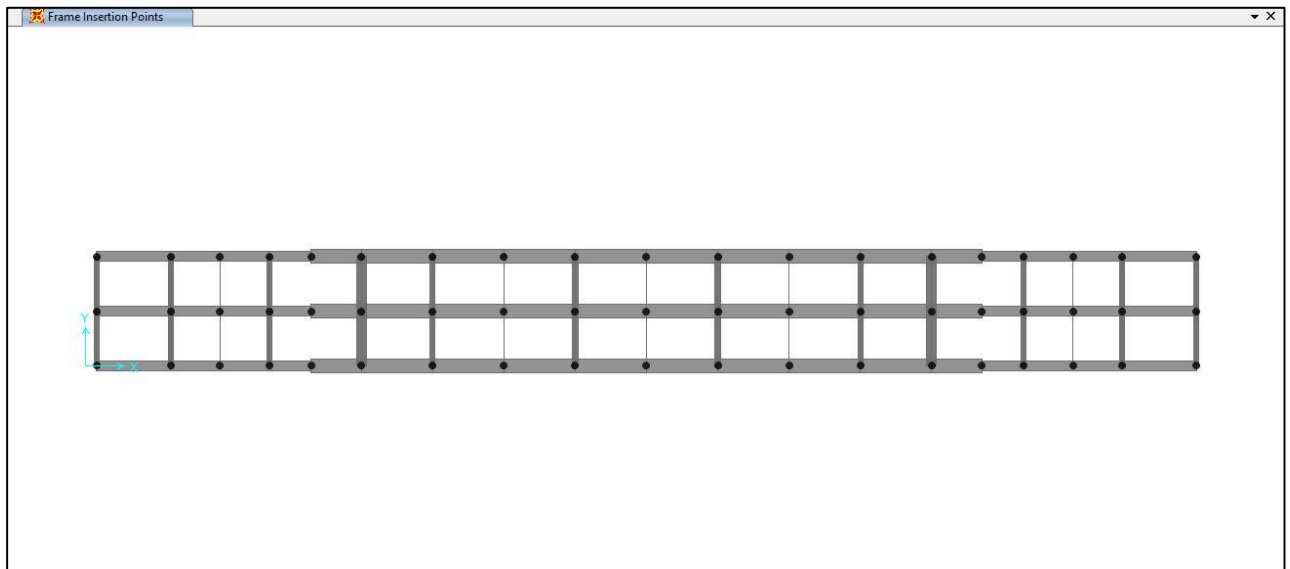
modello di calcolo di Fase 1 – vista solida in pianta
